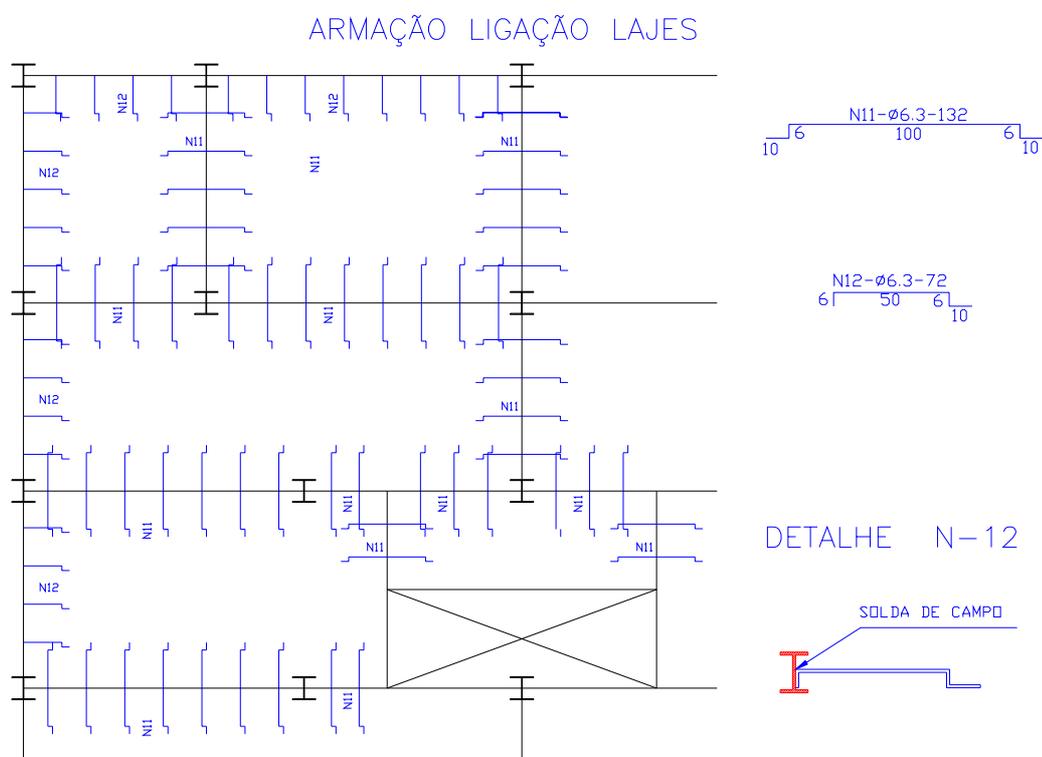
Detalhe das armaduras de ligação das lajes
